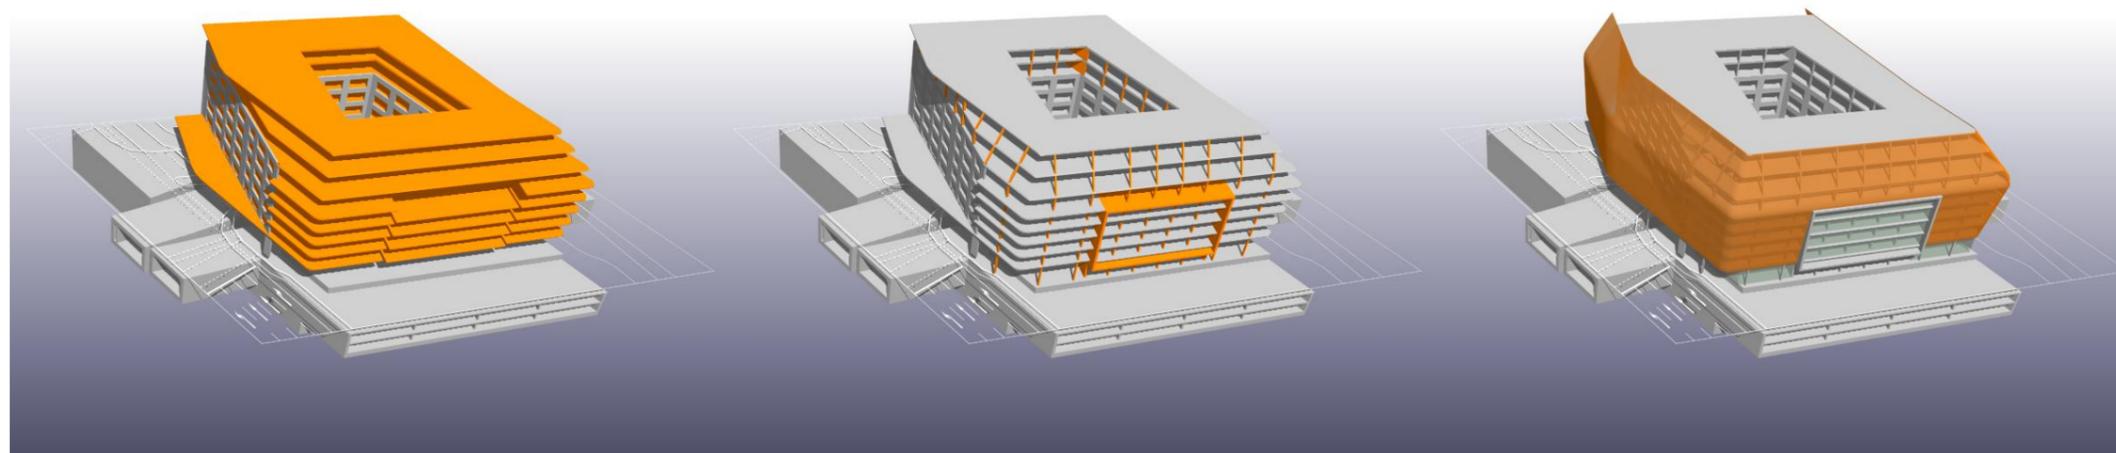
Eintragung der Deckenplatten mit auskragendem Wintergarten Abb. II.13 Hinzufügen von Stützen sowie eines Erkers zur Mittelstraße hin Abb. II.14 Umhüllung der Tragstruktur mit einer leichten Fassadenhaut
